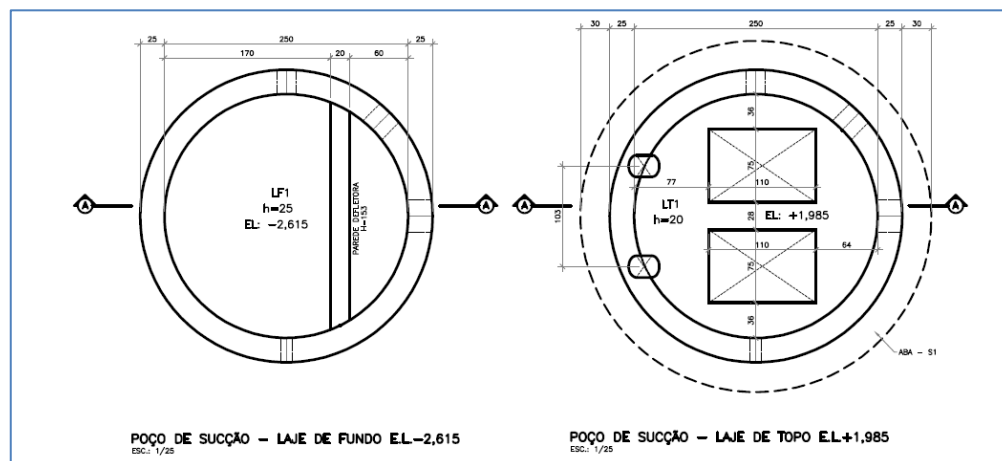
Planta de fundo e topo do poço de sucção da EEEB 1
